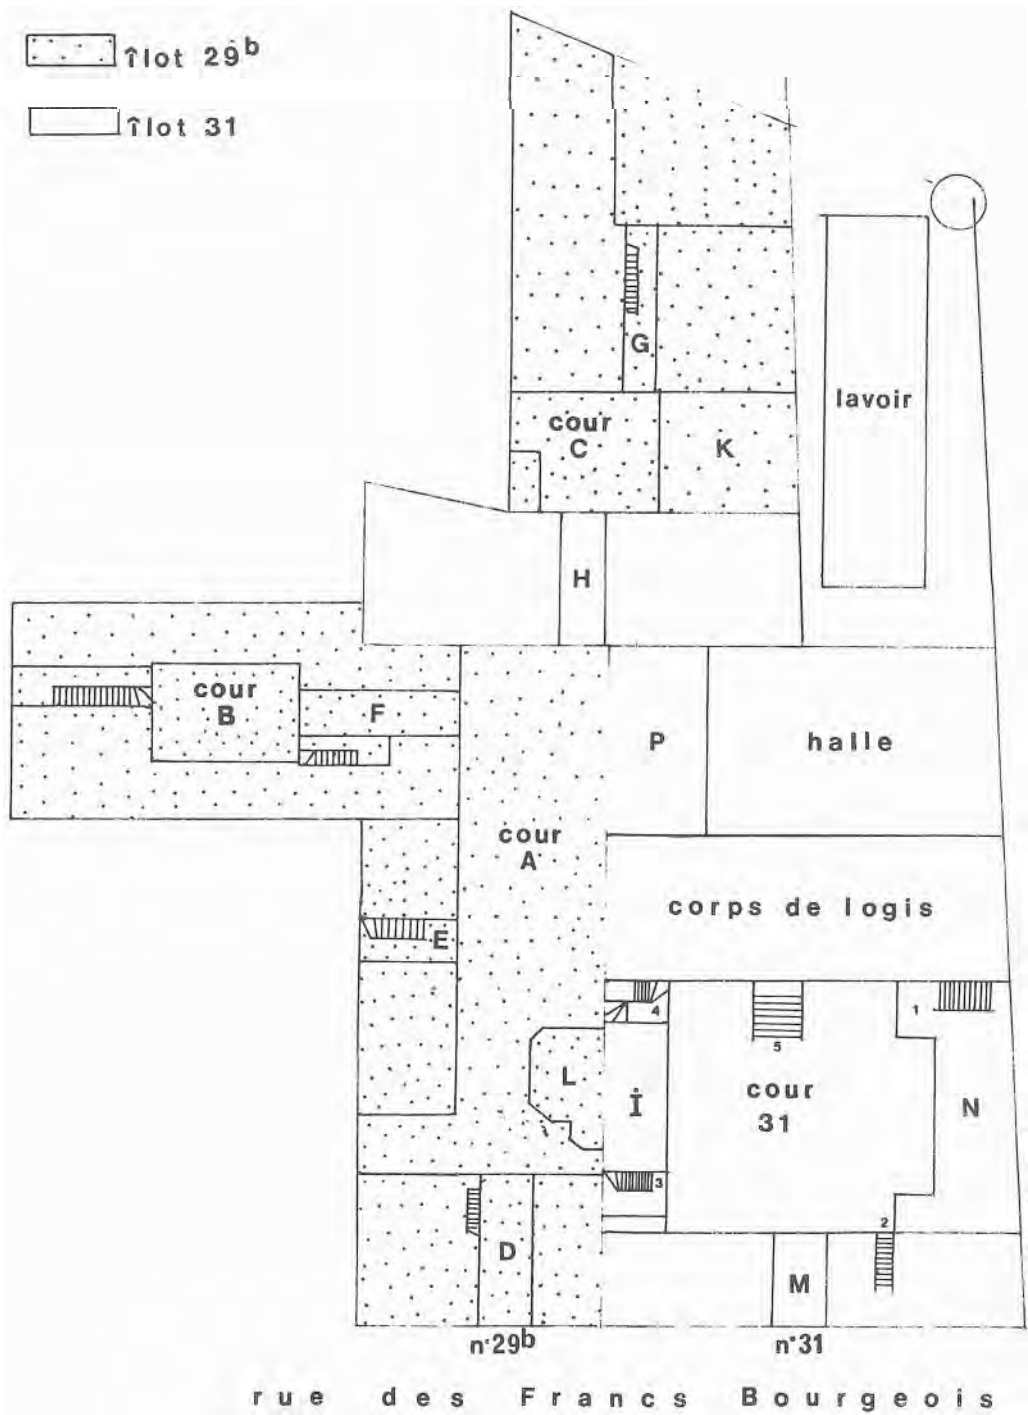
L'Hôtel d'Albret : plan simplifié de l'état en 1977 (le Sud est en bas du plan)
